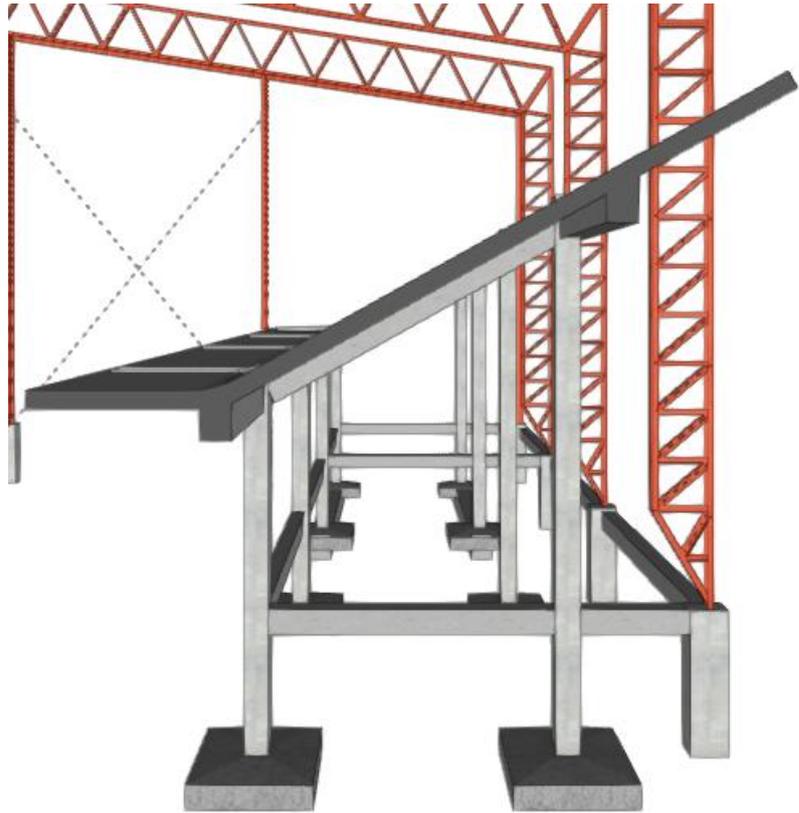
Disposición de vigas en planta y vigas inclinadas
